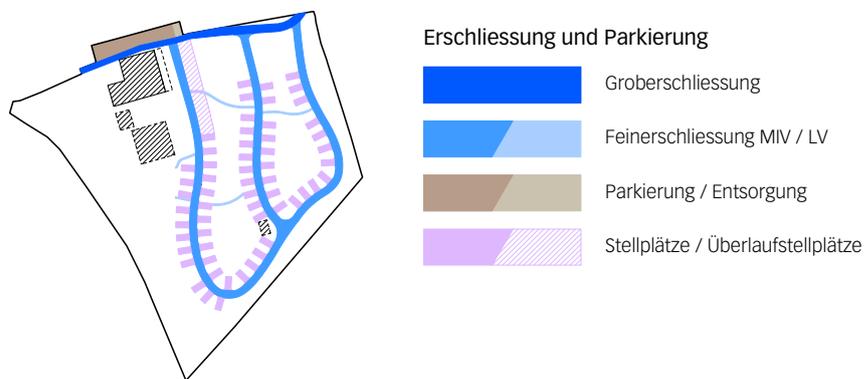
Konzeptplan «Erschliessung und Parkierung»
